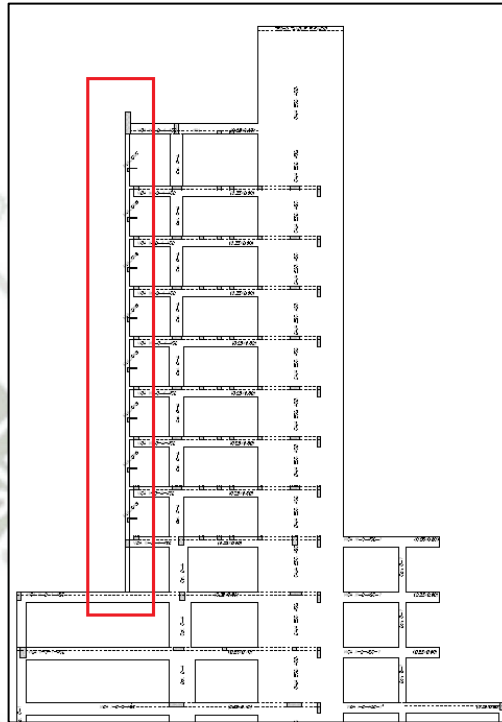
CORTE ESTRUCTURAL MUESTRA MULLIONS
